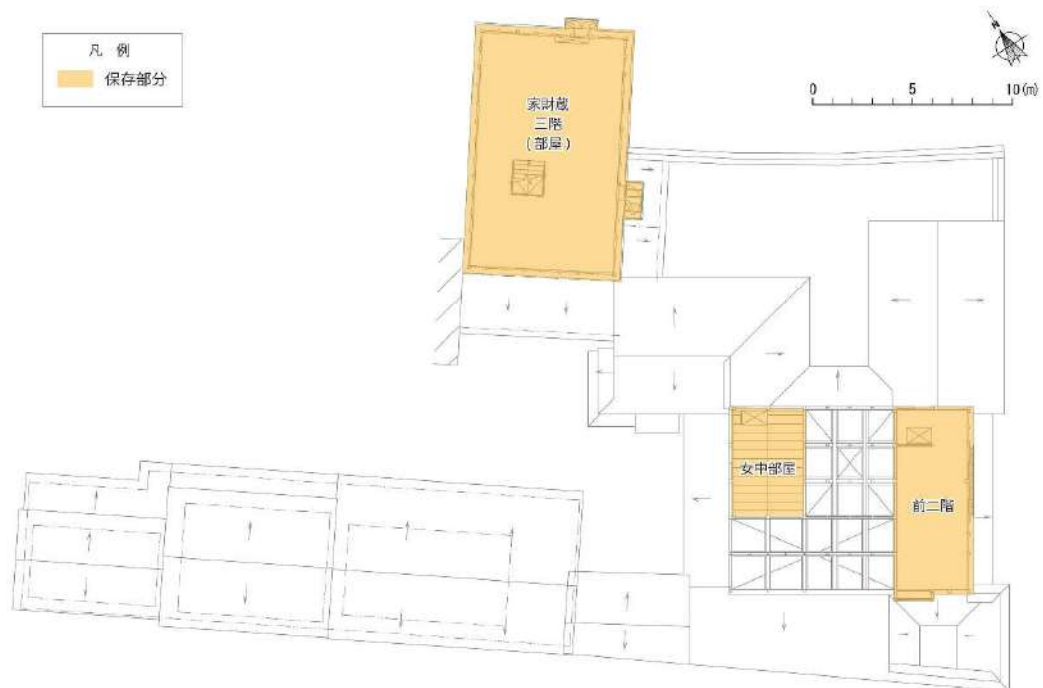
主屋二階、家財蔵三階 平面図（部分の設定）
